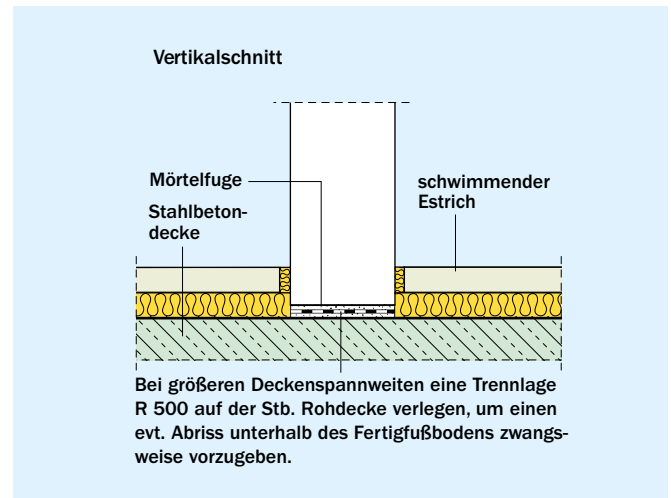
Trennlage am Wandfuß zwischen Mauerwerkswand und Stahlbetondecke
